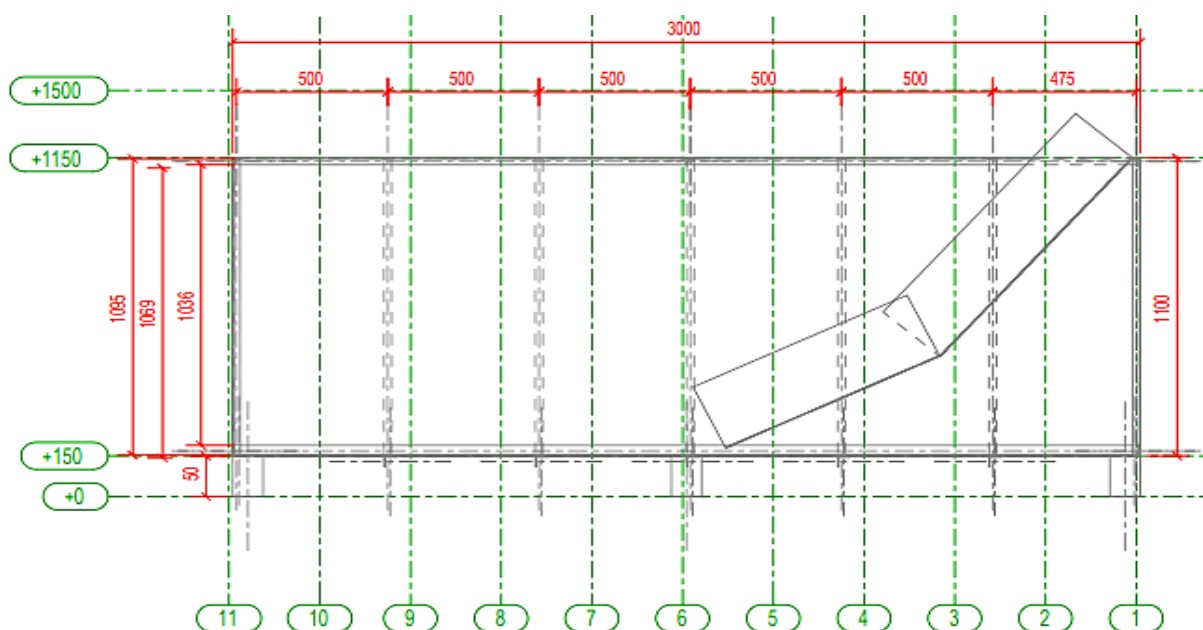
Corte longitudinal do projeto do canal (dimensões em mm)
